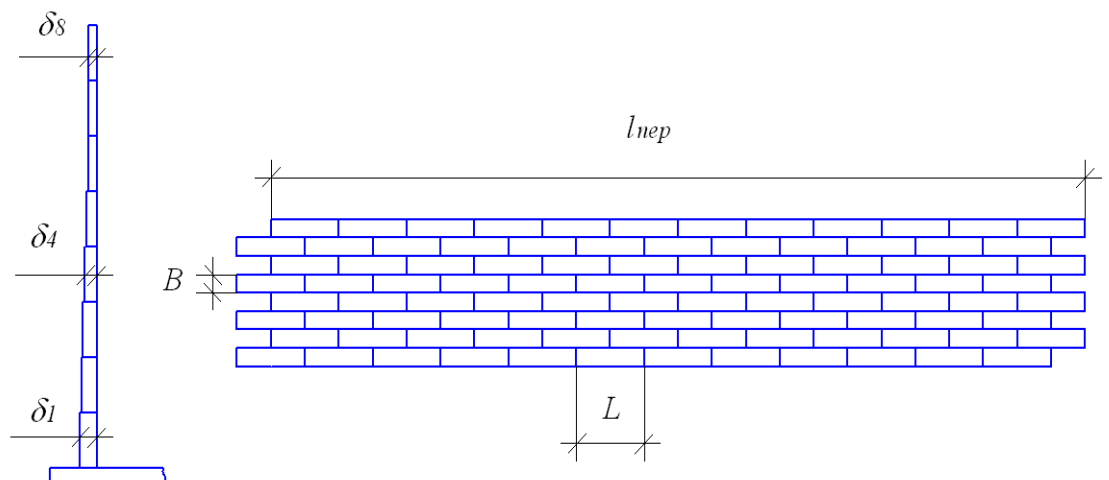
Развертка и сечение стенки вертикального резервуара.
